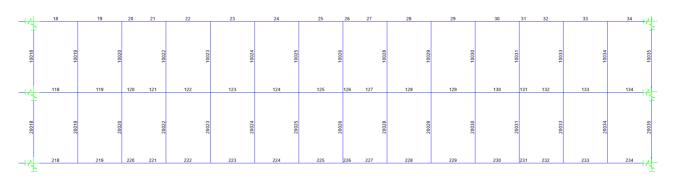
Travi principali, elementi soletta P1 – SP2
